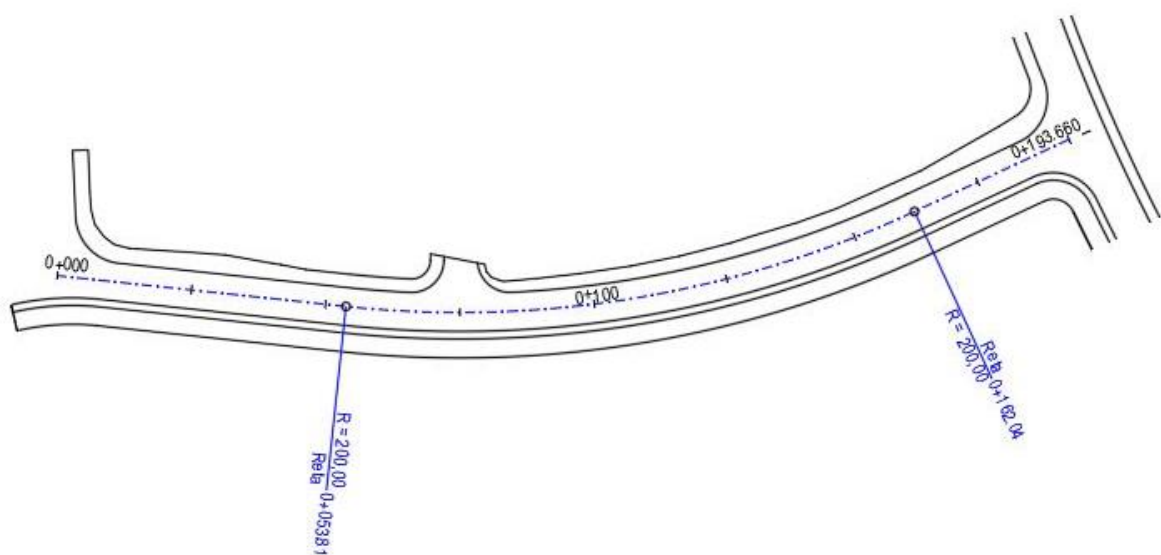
Traçado em planta da Rua 4 da VCU.
